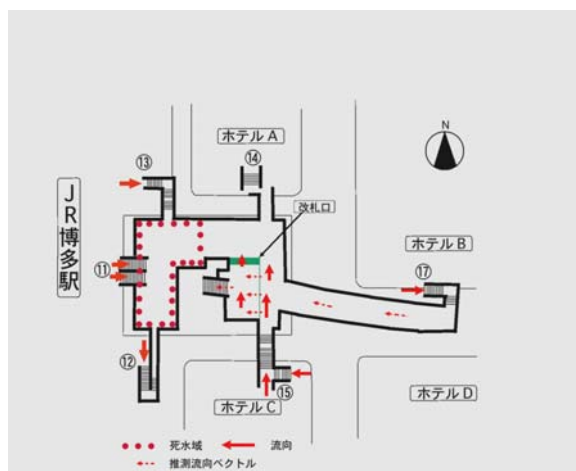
地下鉄博多駅筑紫口（地下1階）の平面図
